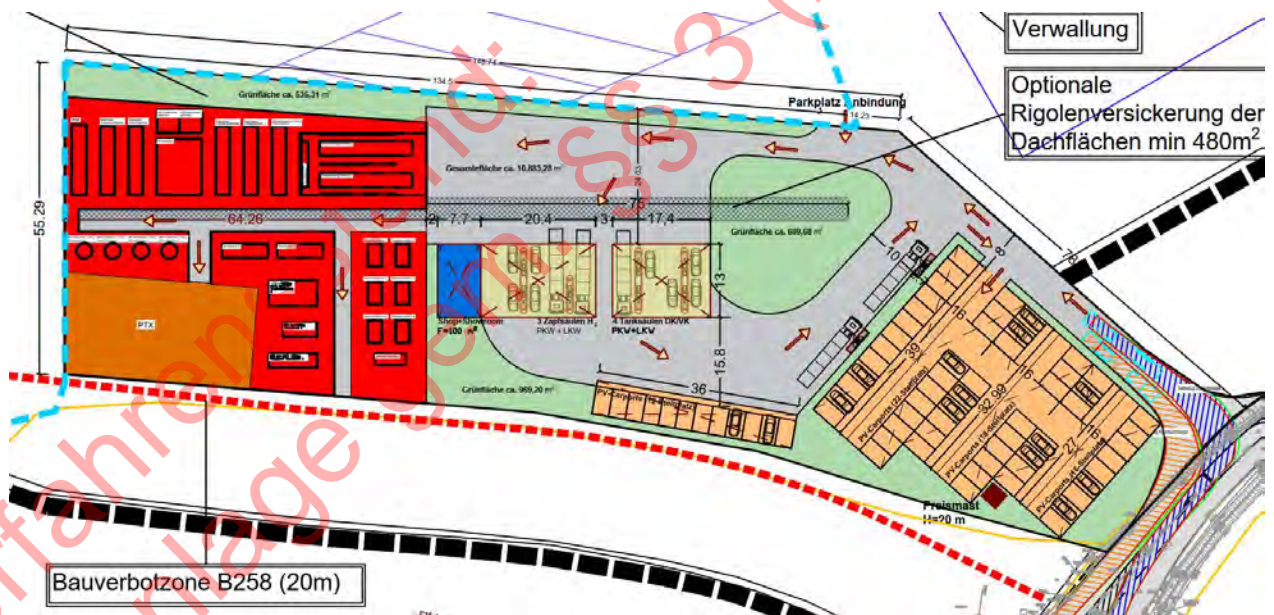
Ausschnitt Lageplan „grüne“ Tankstelle
